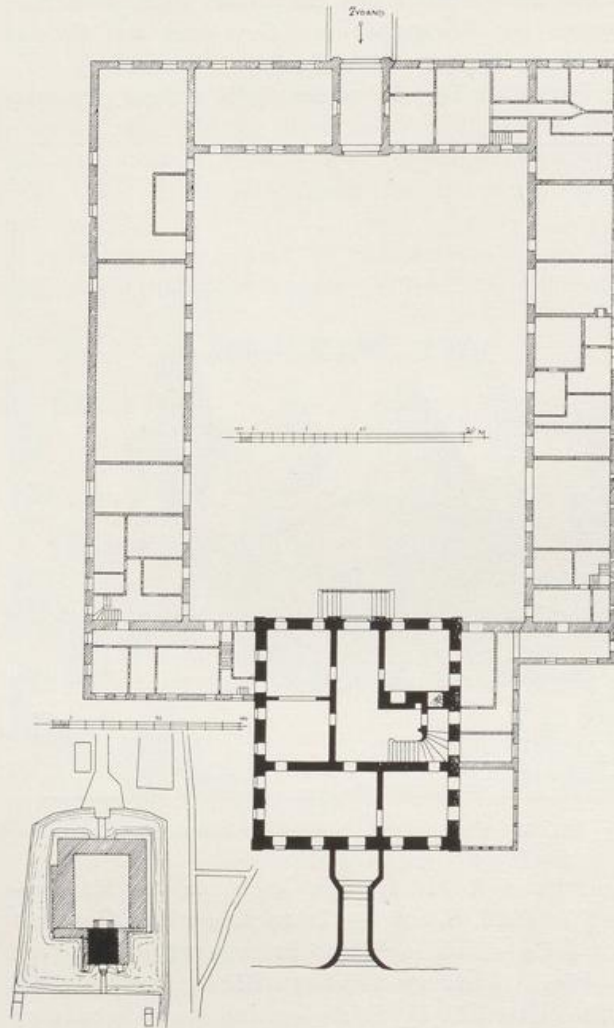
Müddersheim. Lageplan und Grundriss des Schlosses.
